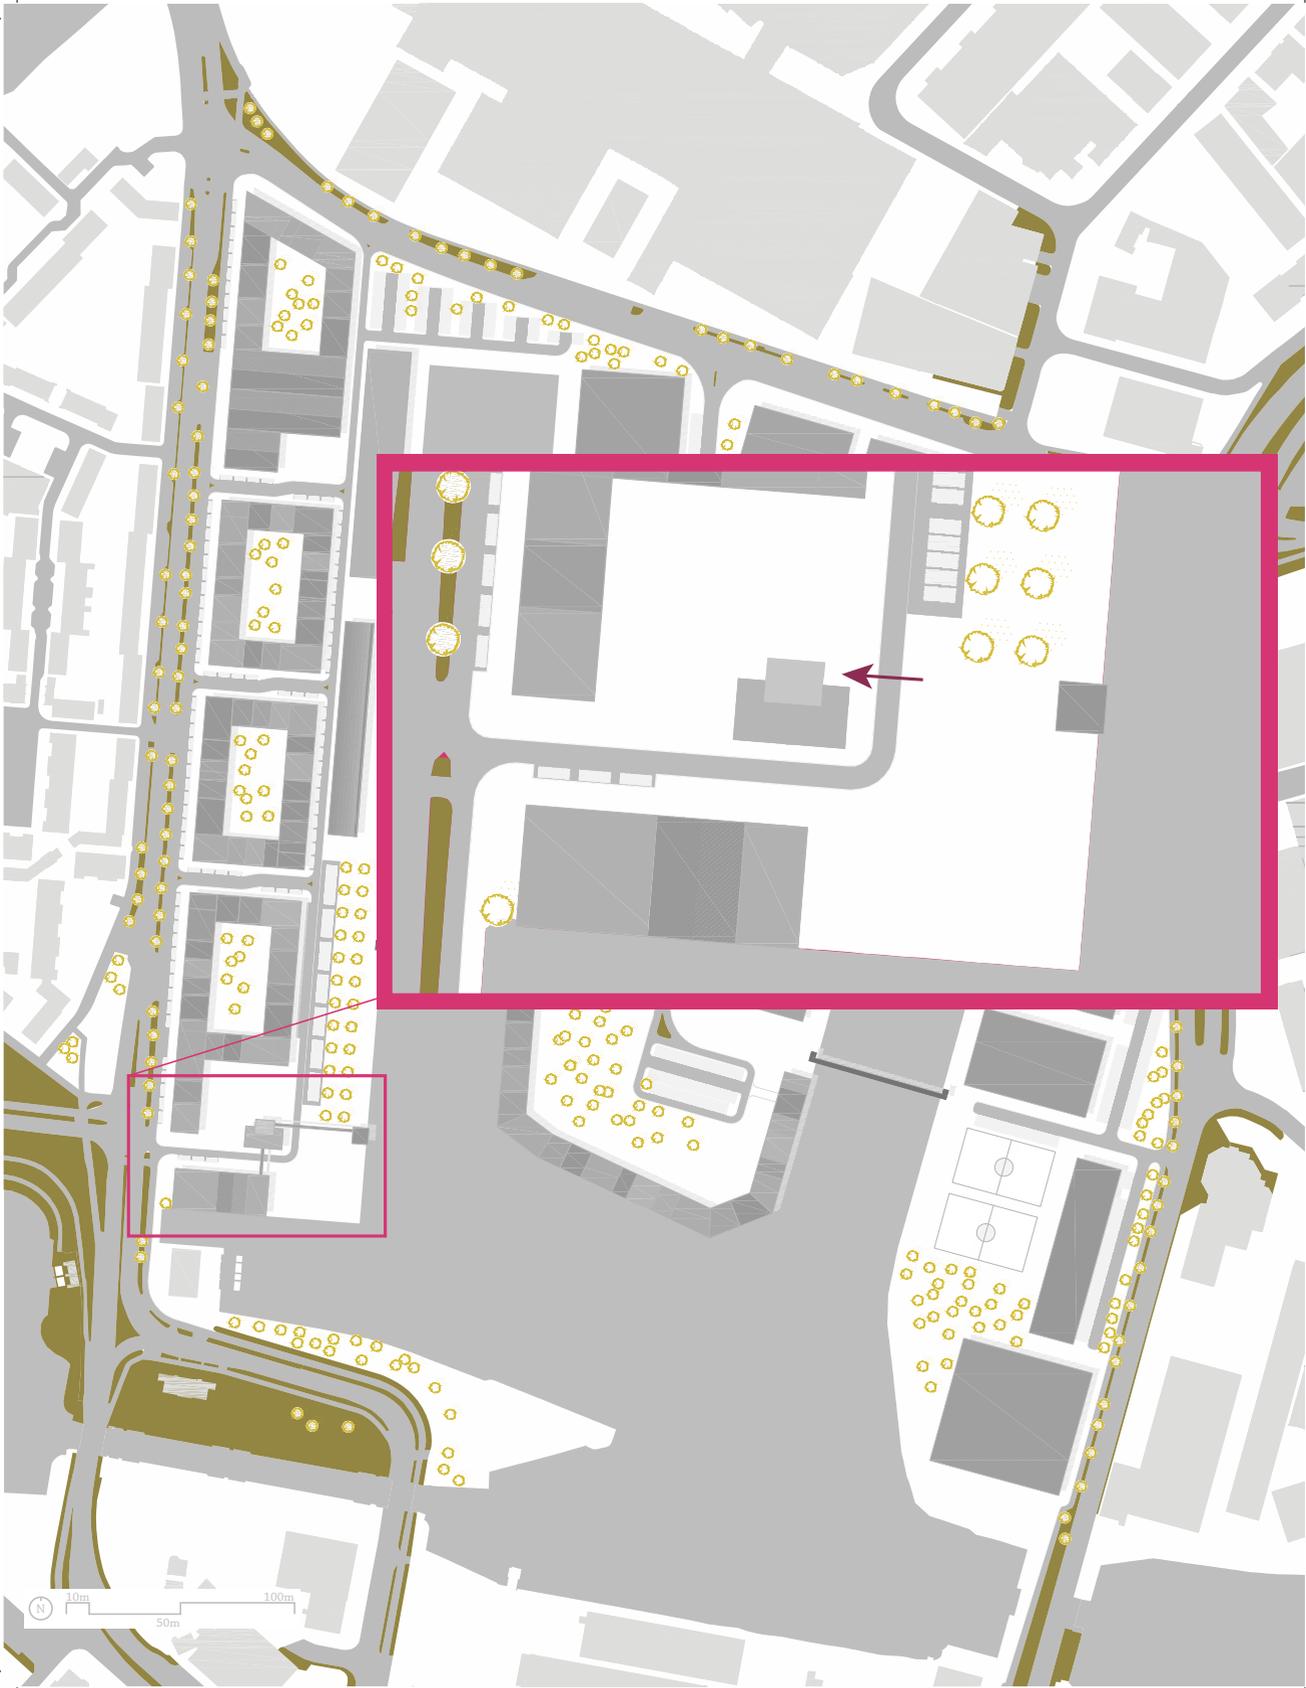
Grundriss Verteilerraum Bestand
